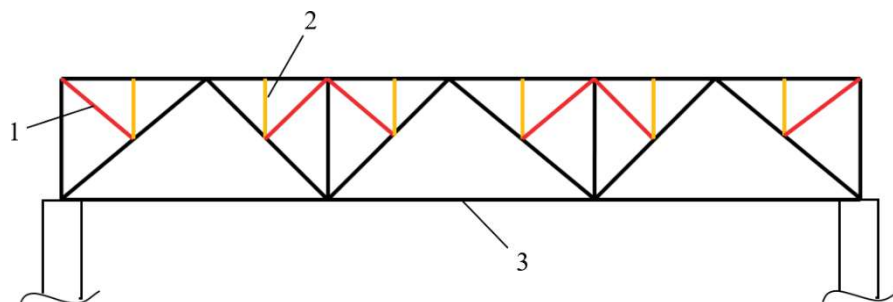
усиление сжатых поясов и раскосов: 1 — дополнительные раскосы, 2 — подвески, 3 — усиливаемая ферма
